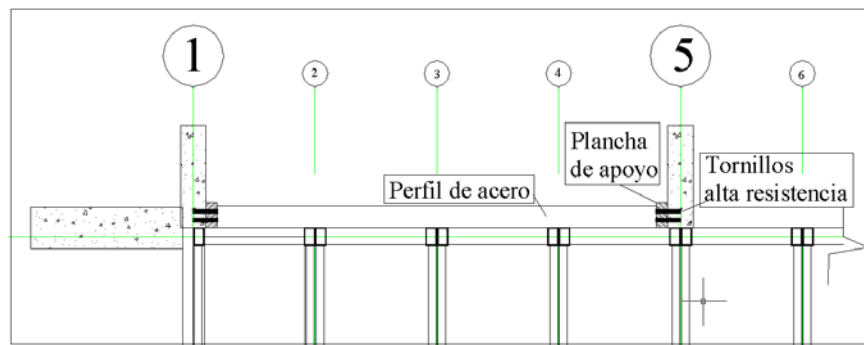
Opción 1. Vista de planta de sistema para garantizar diafragma rígido.
